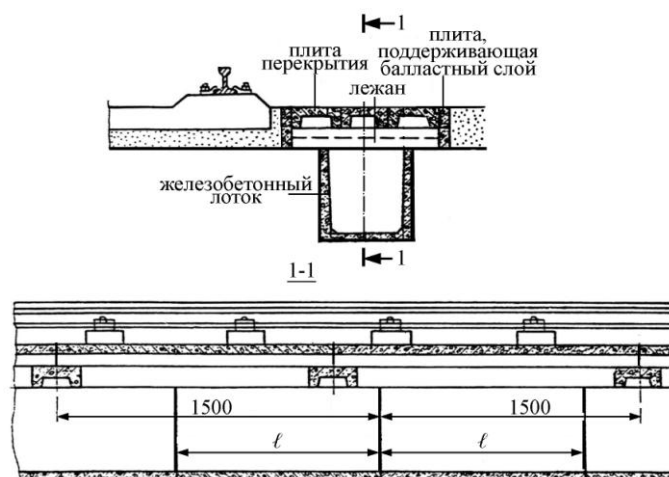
Водоотводная канавка, закреплённая железобетонными лотками
